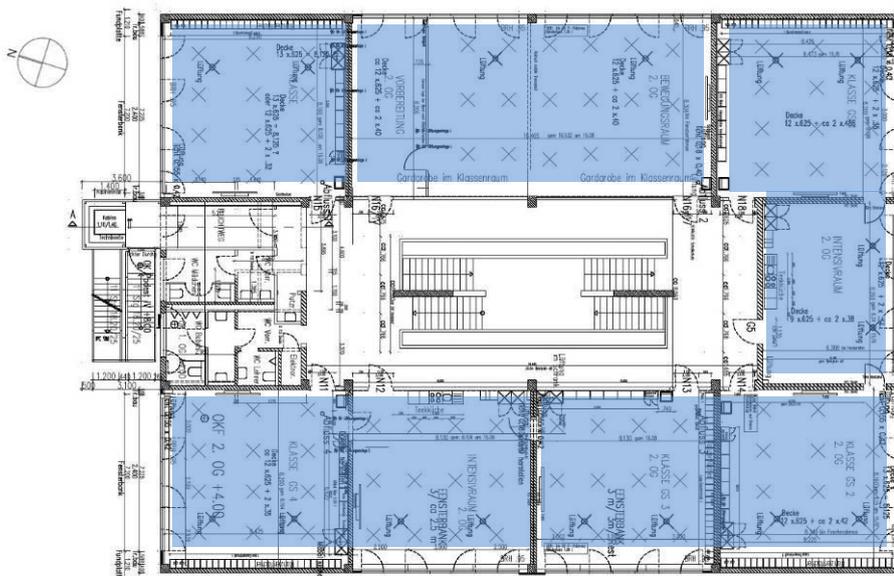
Grundriss der Konrad-Adenauer-Schule in Offenburg.
